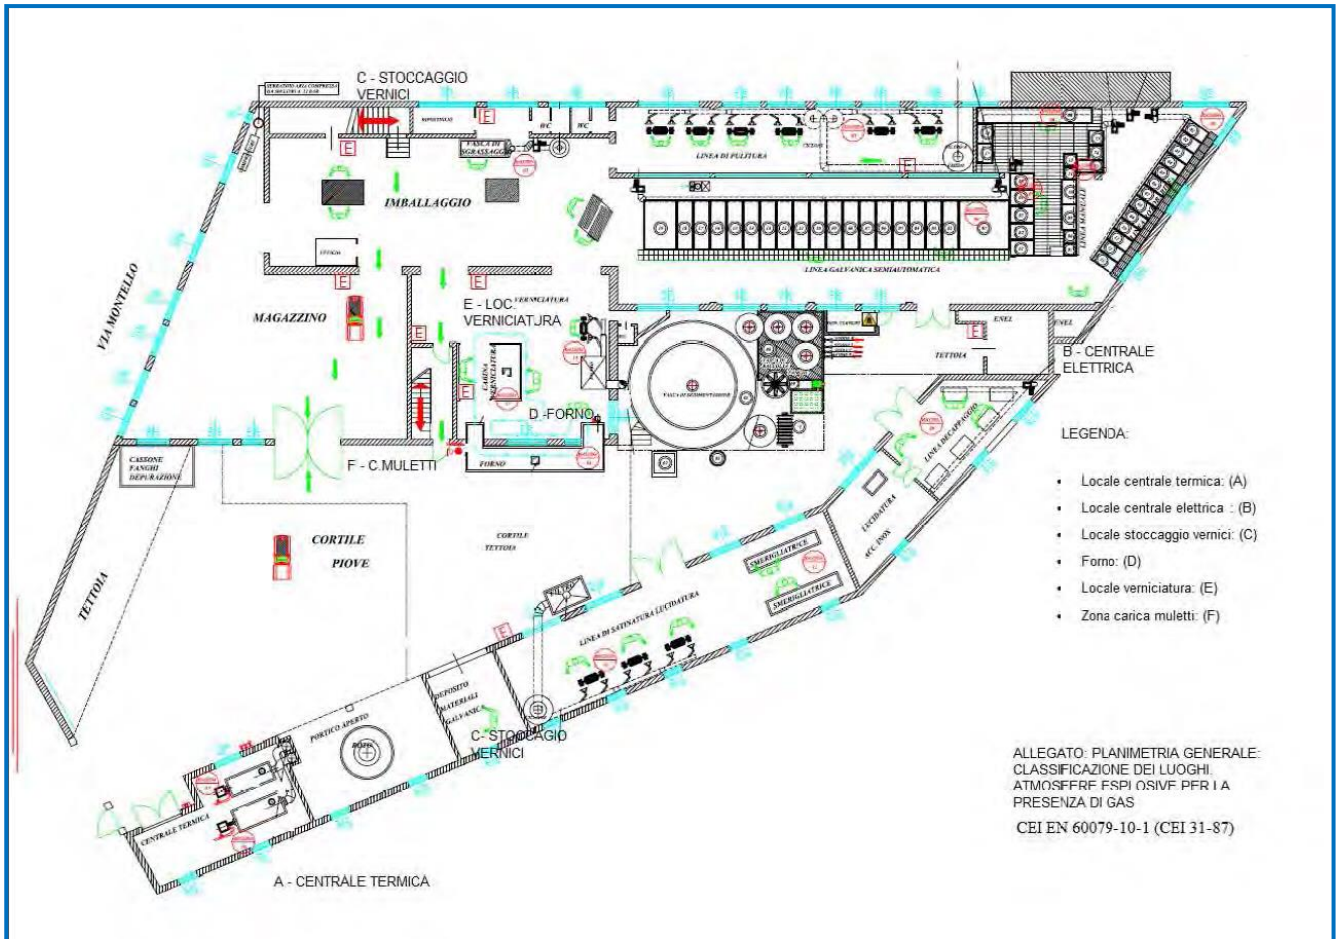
Planimetria stabilimento - Fonte: Piano di Emergenza Esterno
